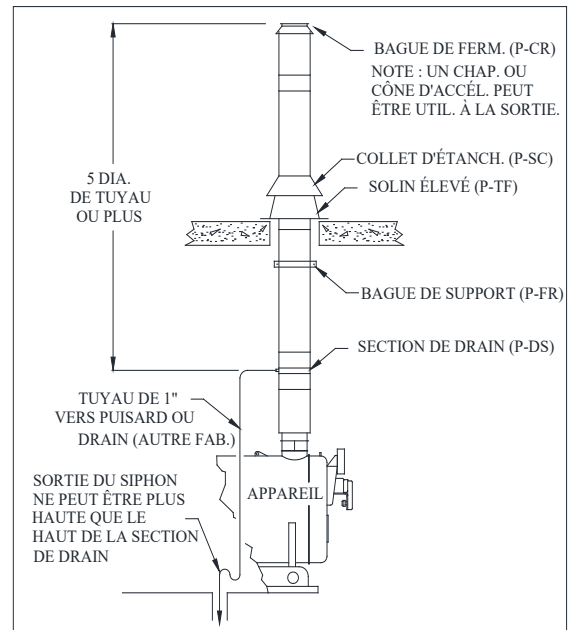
Installation requise pour la section de drain (P-DS)
